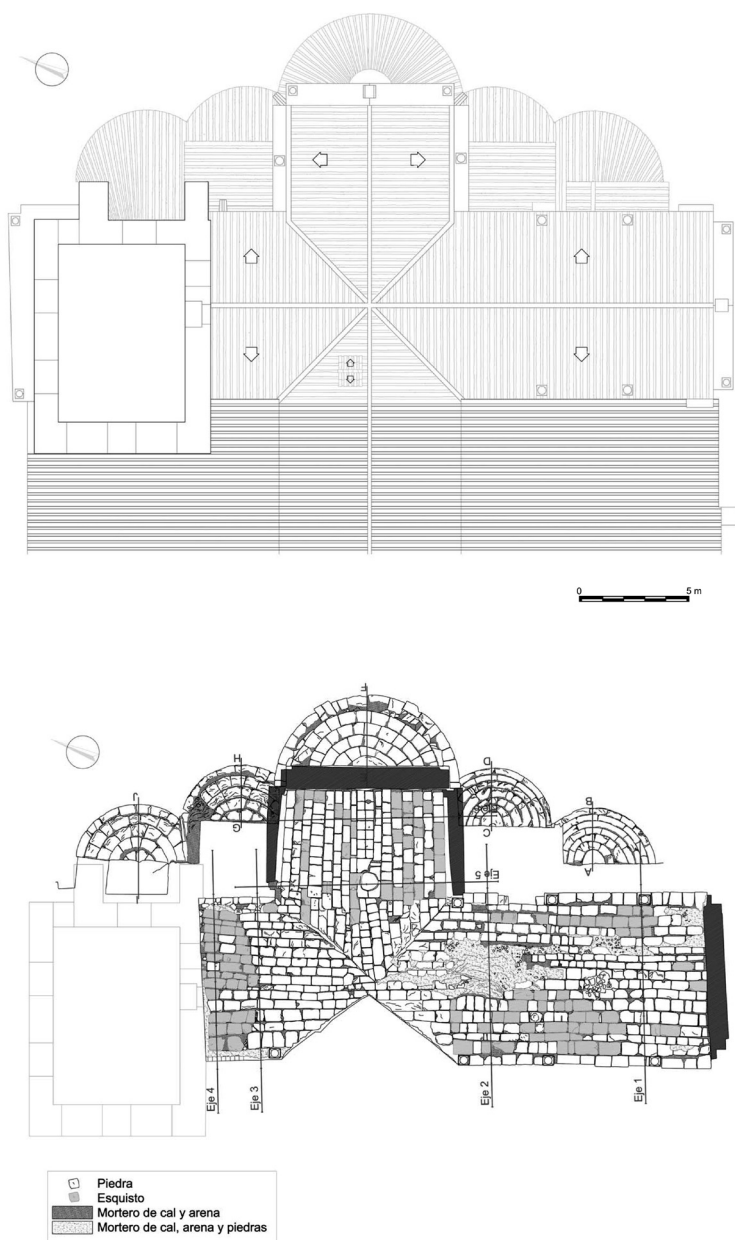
Planta general de las cubiertas de la iglesia; b: Planta de las cubiertas de la iglesia con los restos documentados.
